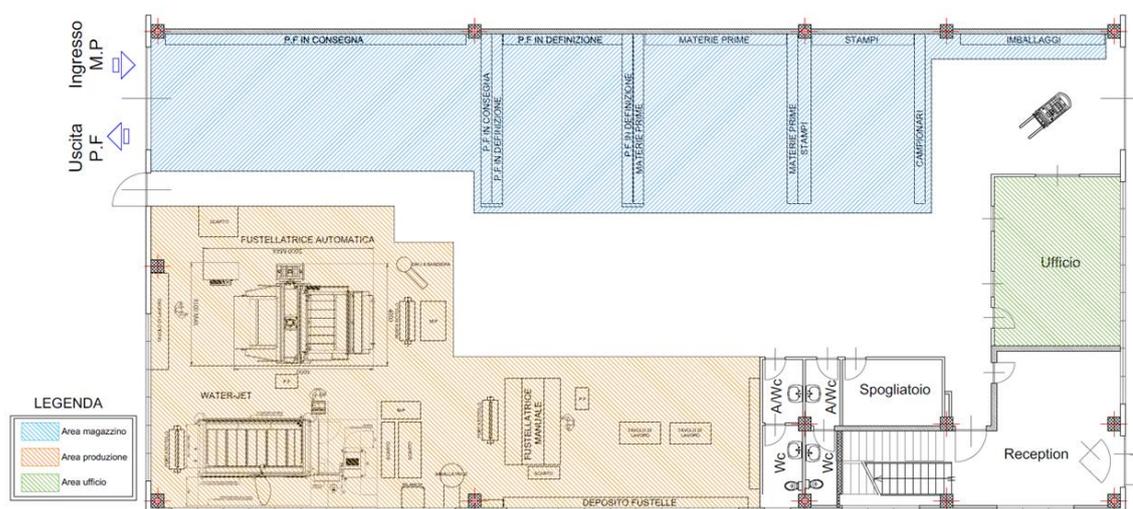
Planimetria piano terra dello stabilimento Sargomma
